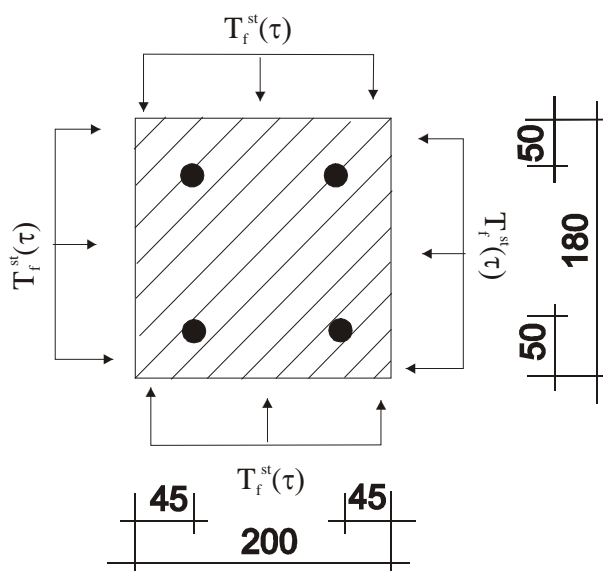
Поперечное сечение нижнего пояса заданной железобетонной фермы и схема воздействия пожара на этот элемент.
